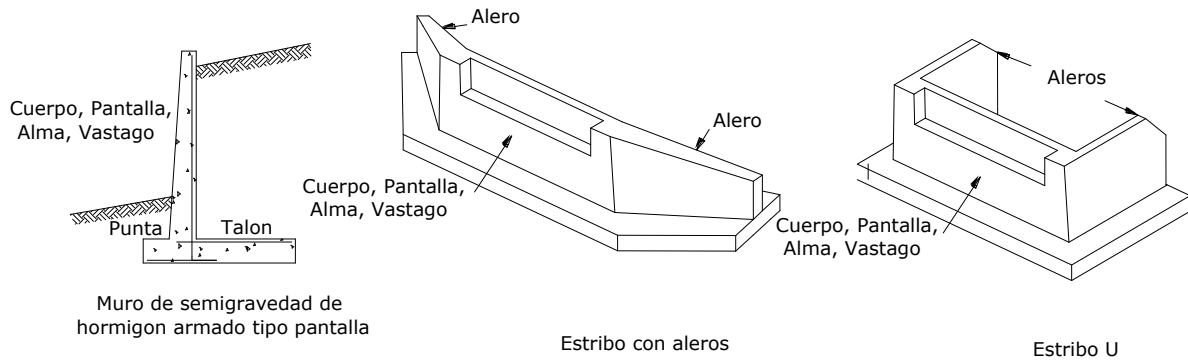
Estribo tipo semigravedad en voladizo
